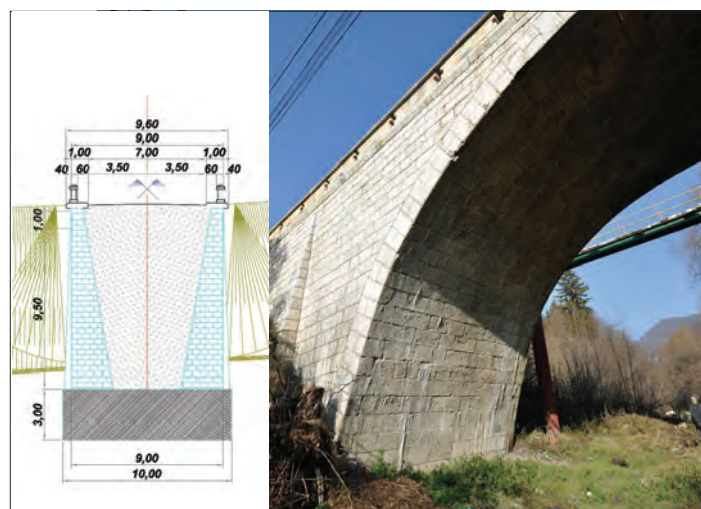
Secțiunea transversală prin nașterea bolții.
